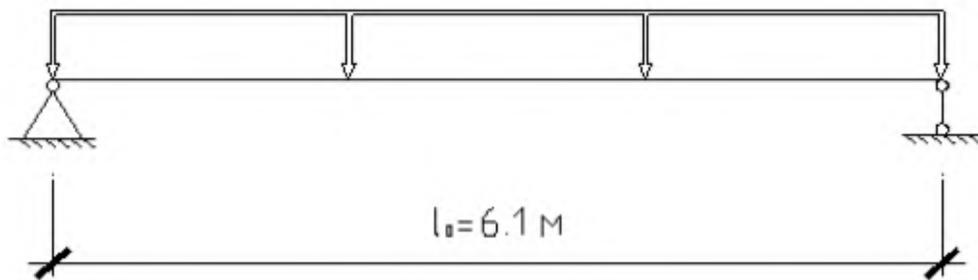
Схема завантаження багатопустотної панелі перекриття
